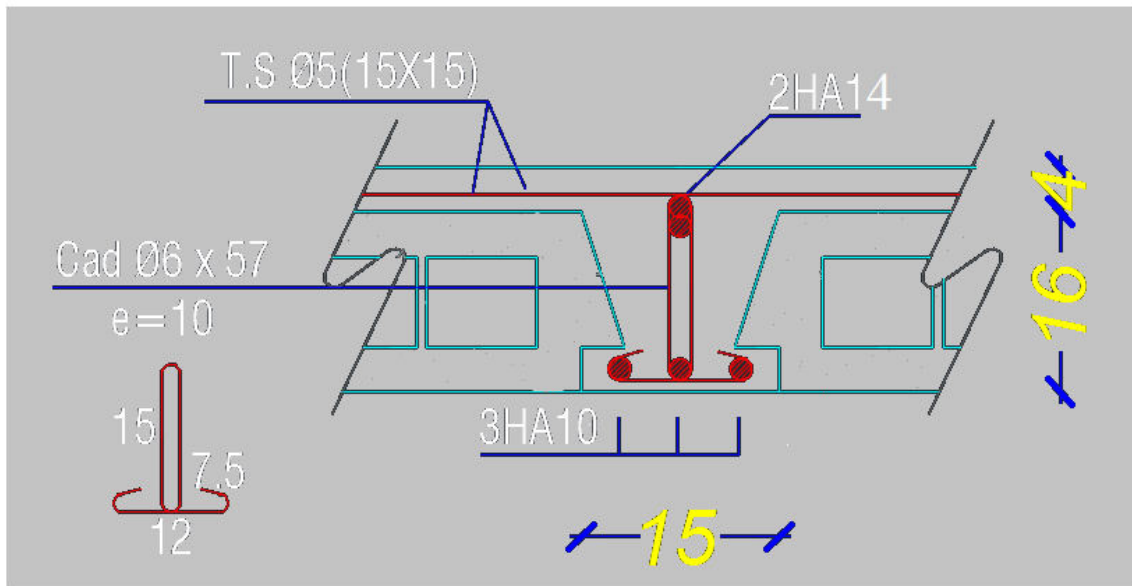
Disposition des armatures dans la poutrelle type 2 (appuis)
